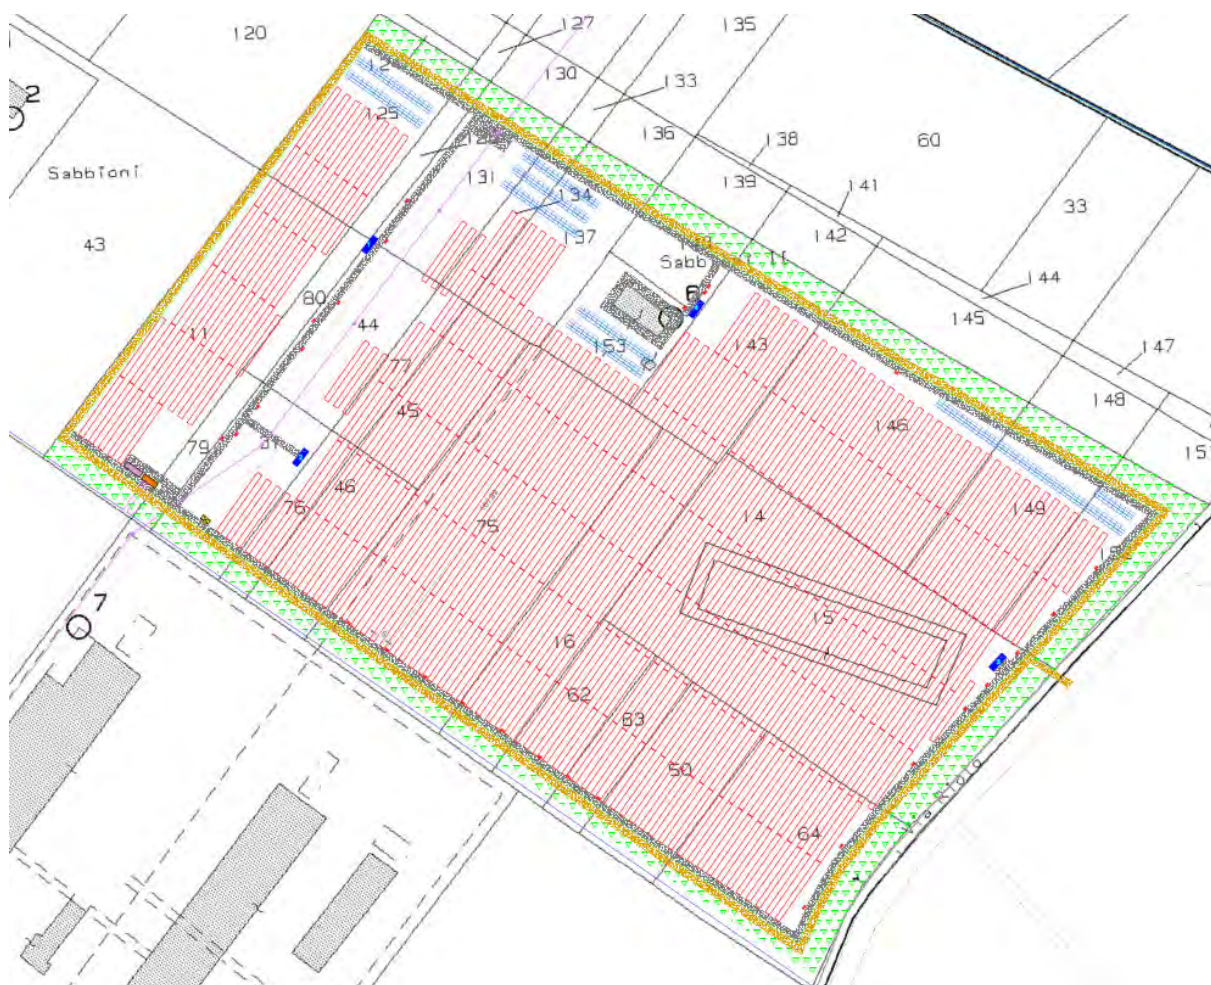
Stralcio planimetria catastale (stralcio elab. FV-SAG-PD-T2-0)
